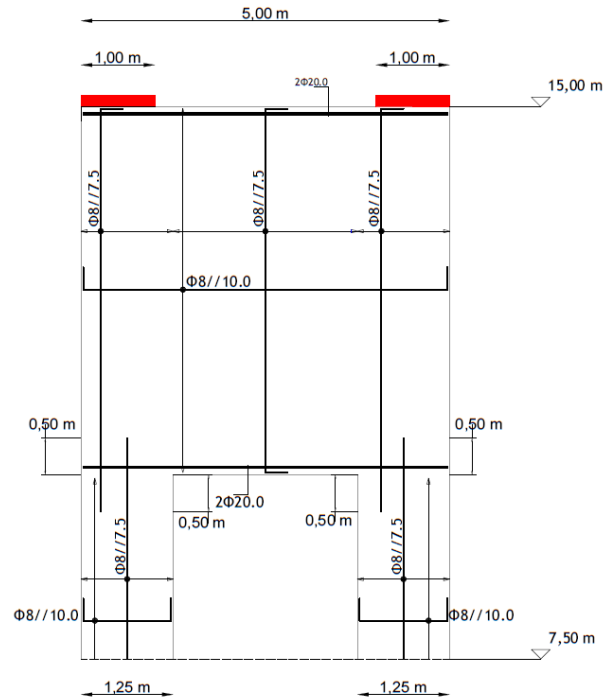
Vista em alçado da pormenorização das armaduras principais e suplementares da metade superior parede com abertura a executar para cada uma das faces.
